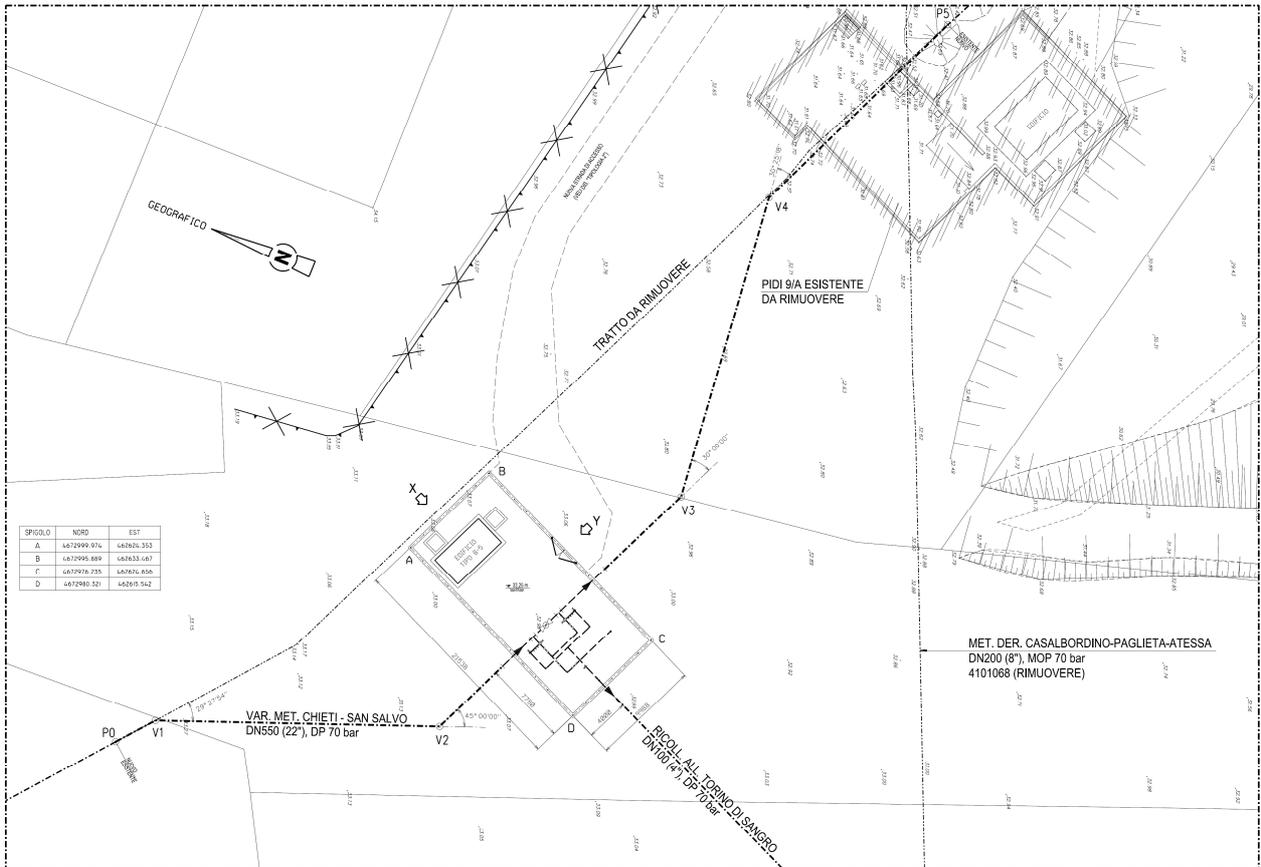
Planimetria e prospetti impianto PIDI n. 18.2.
